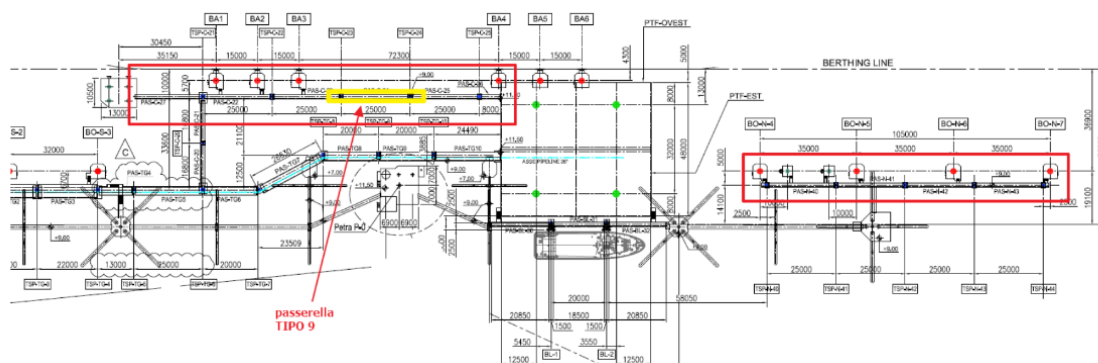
Planimetria Passerelle di Collegamento delle Briccole
